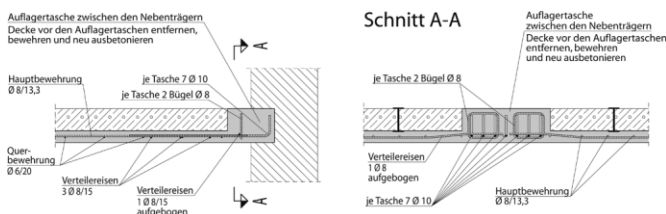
Detail Randauflager der verstärkten Decke in den Obergeschossen
